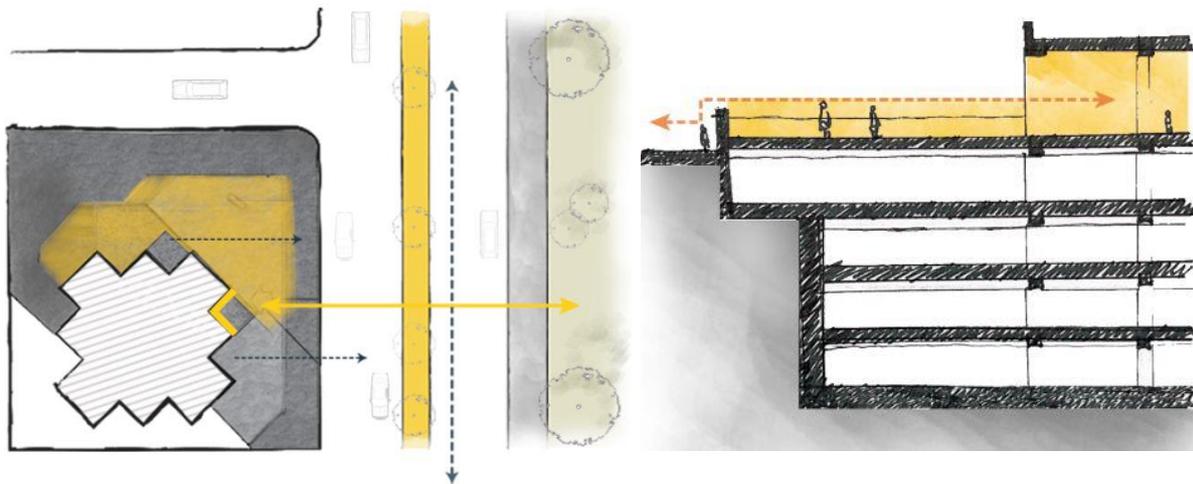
Edificio COFIEC en planta y corte. Elaboración propia
